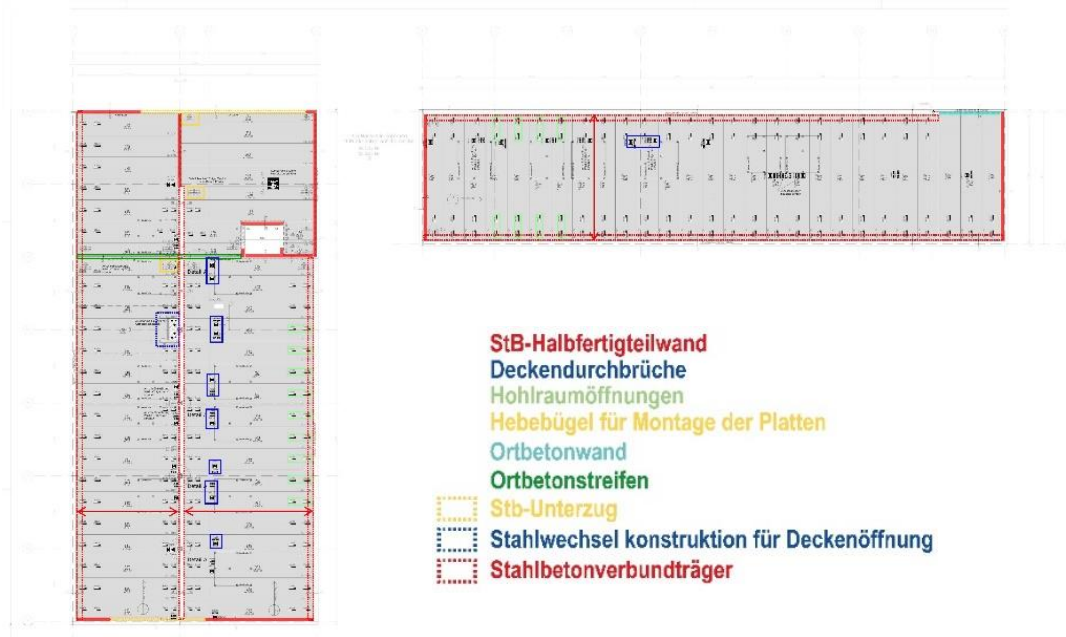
Montageplanung der Spannbeton-Hohlplatten am Beispiel der Deckendartstellung von Haus A - Decke über EG, [DW Systembau GmbH]
